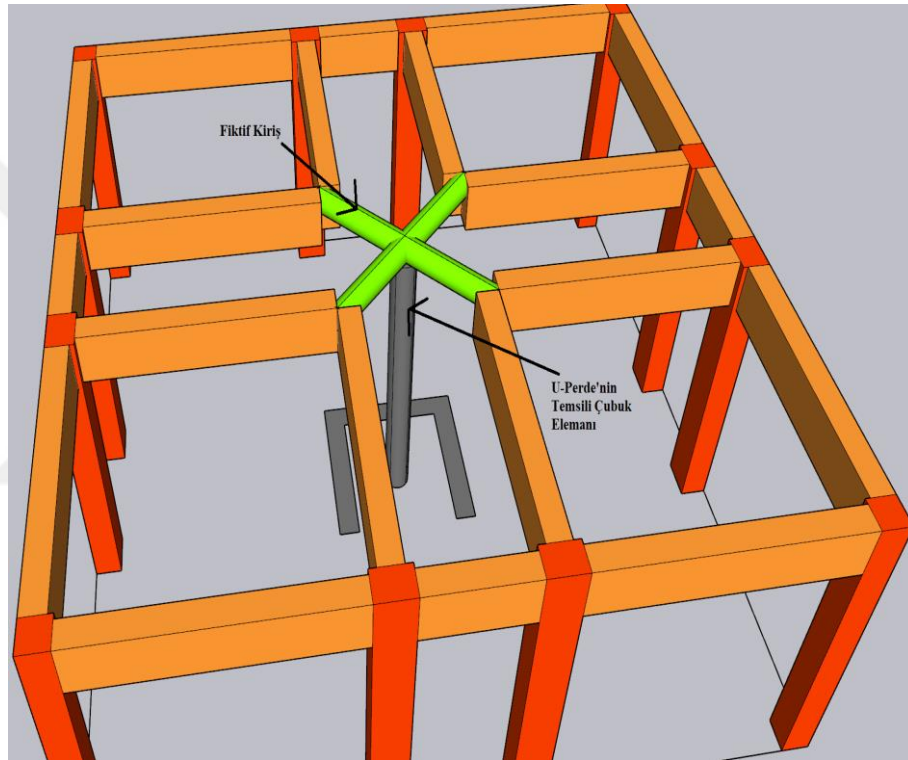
Orta kolon modeli betonarme perdenin enkesit merkezleri
